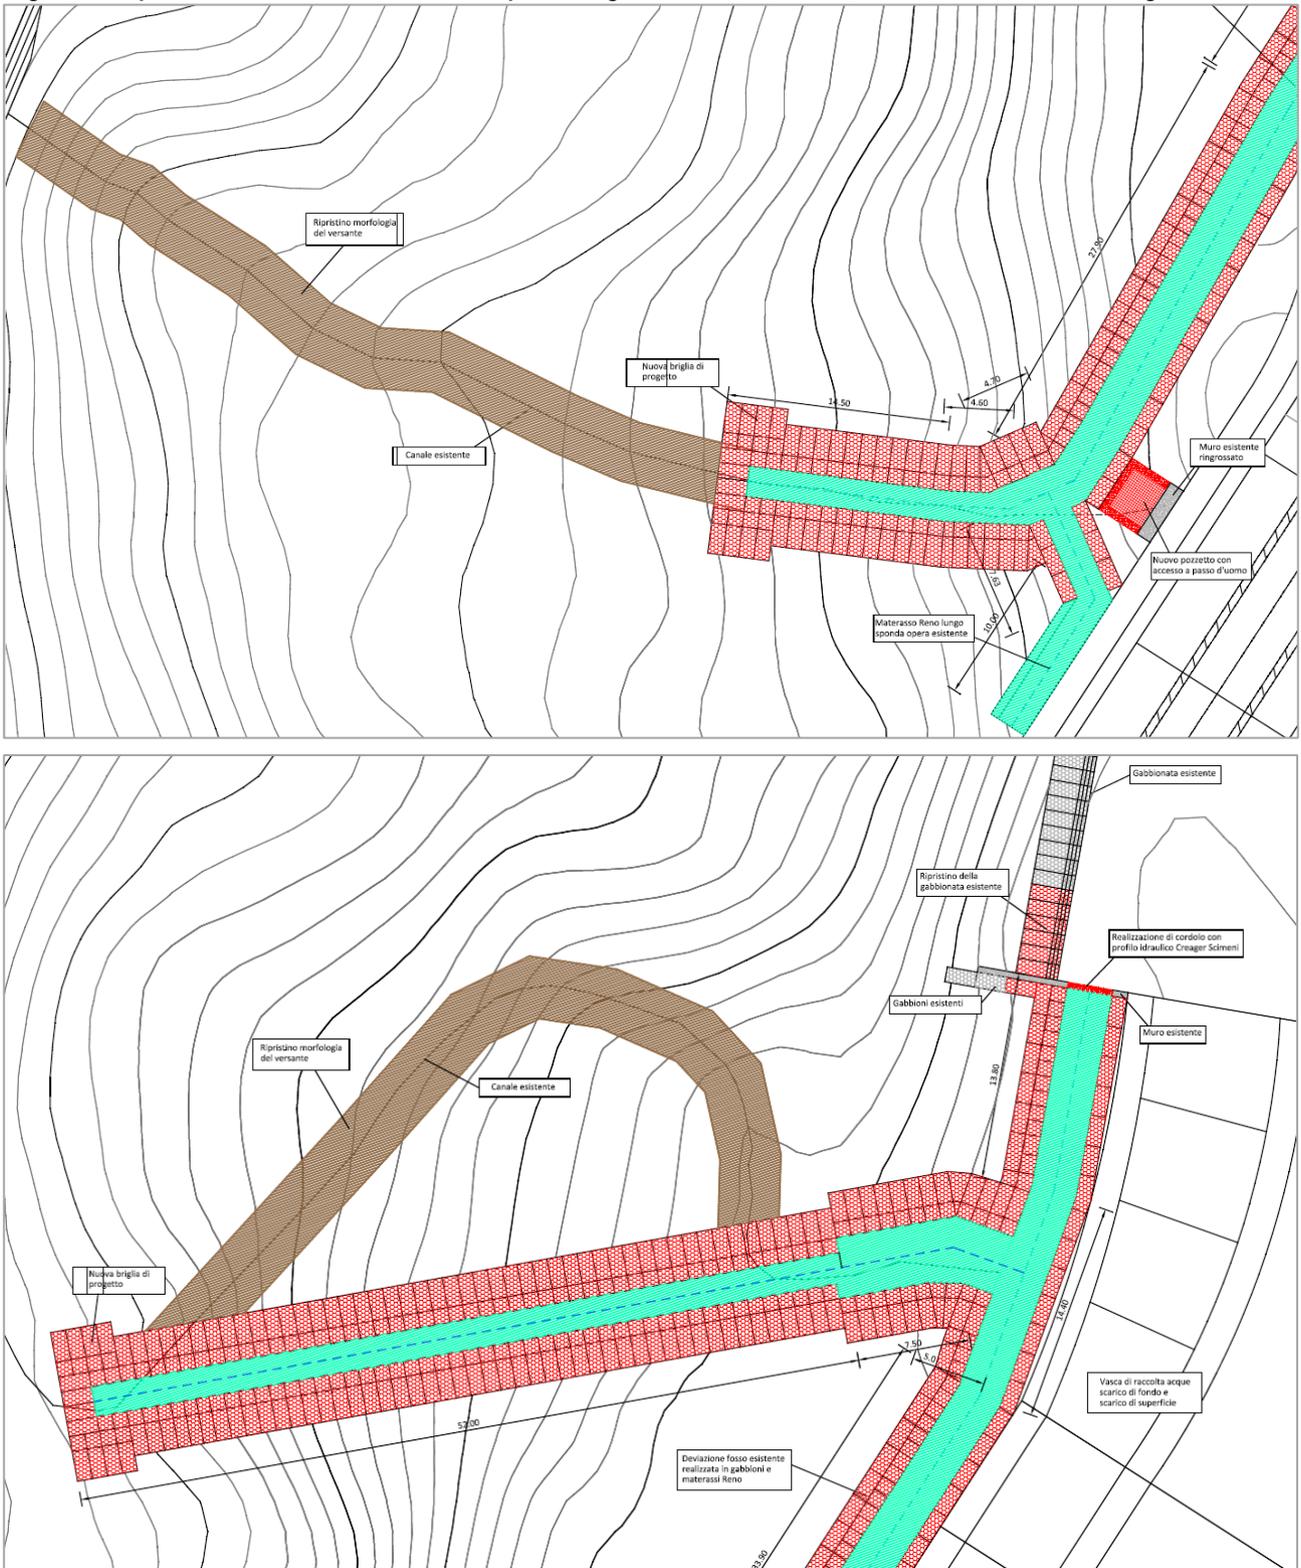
particolari estratti dall'elaborato "Opere di regimentazione idraulica_Planimetria e ubicazione degli interventi"
